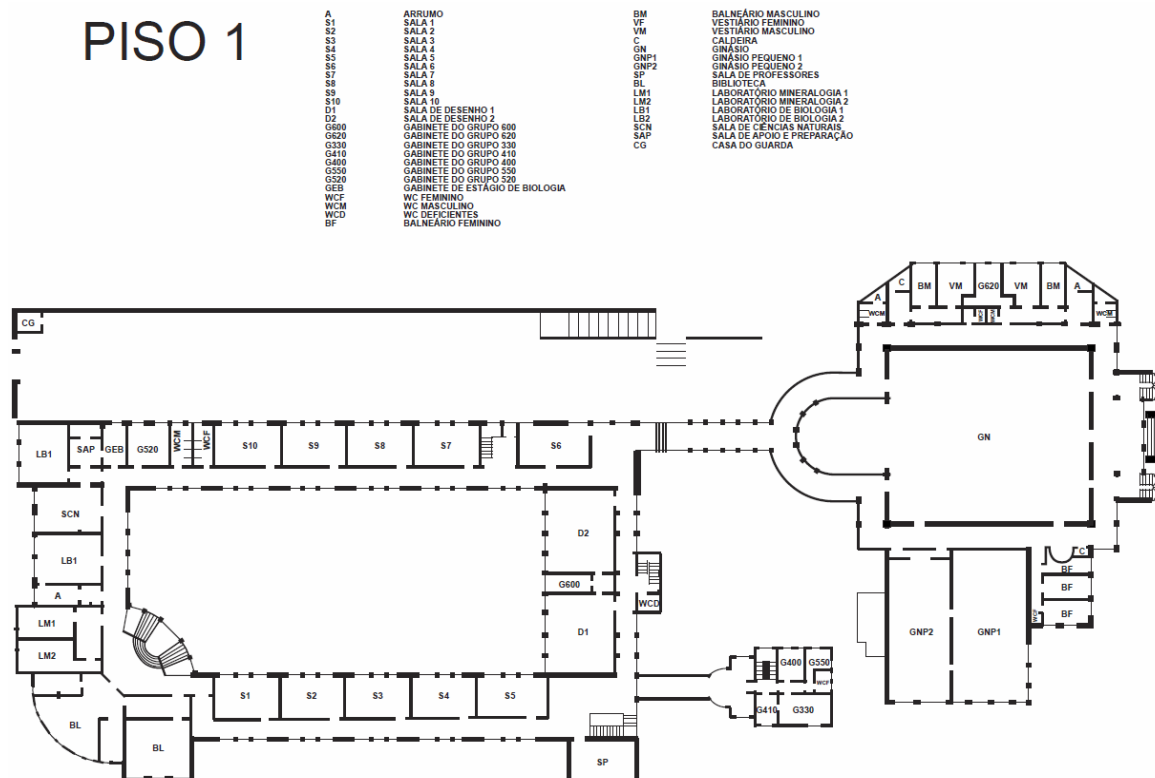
Escola Secundária José Falcão. Planta do 1.º piso. (Fonte: Arquivo ESJF)
